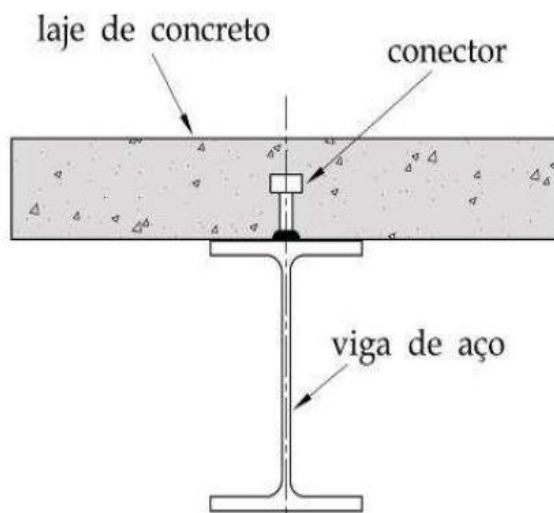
Exemplo de secção de viga mista (Figueiredo, 2014)
